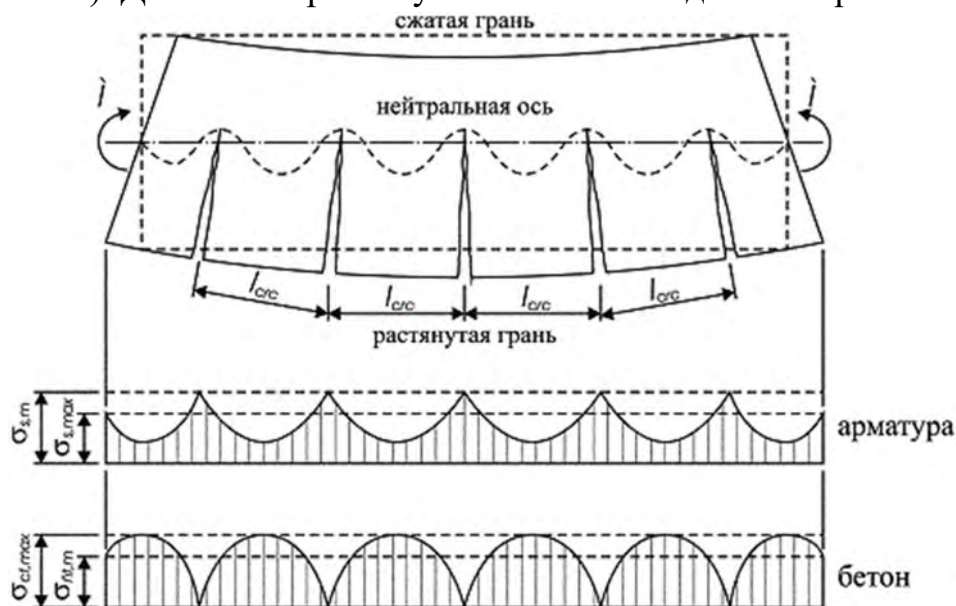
Распределение напряжений в растянутой арматуре и растянутом бетоне для железобетонной конструкции в стадии 2
